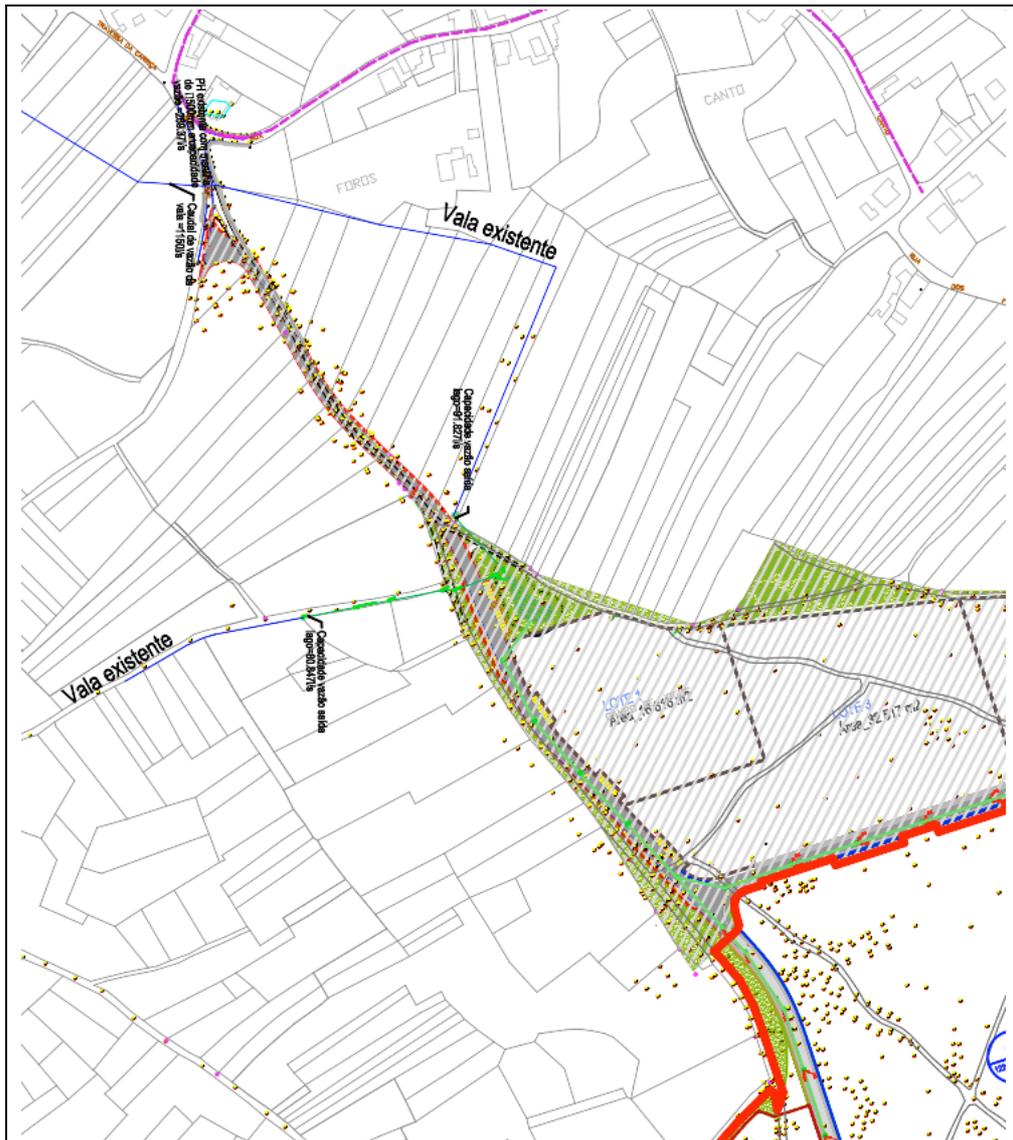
Drenagem e descarga de águas pluviais (sector norte).
